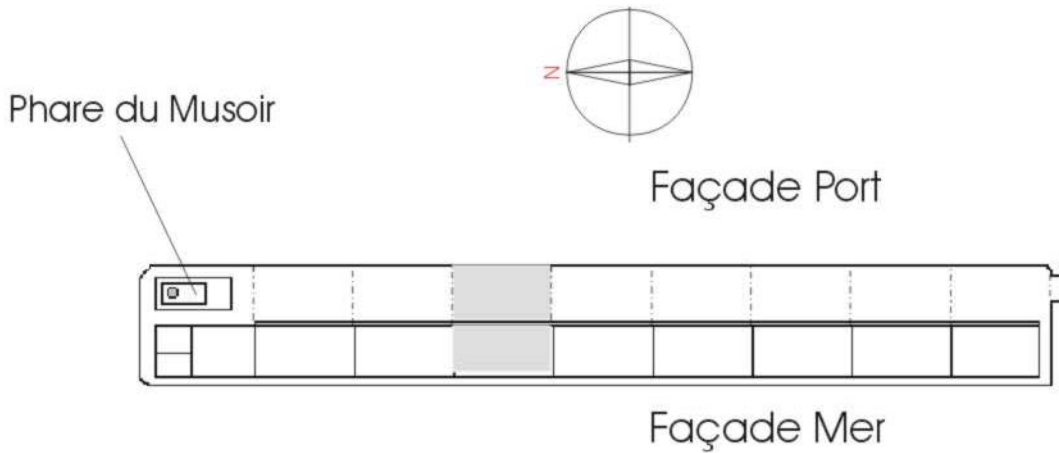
Vue en plan de la digue Ouest (en grisé : le caisson instrumenté).
